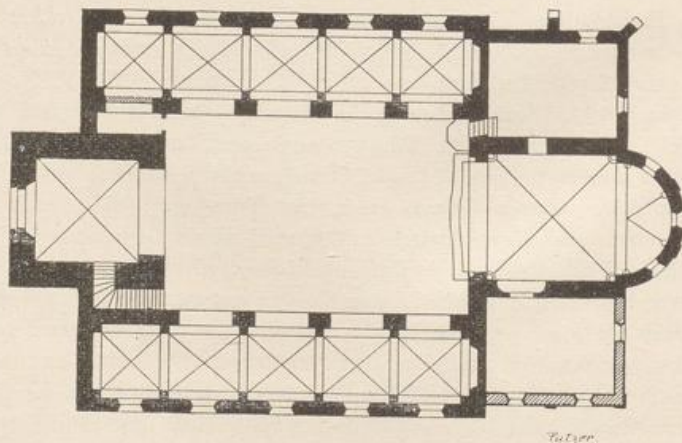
Wittlaer. Grundriss der katholischen Pfarrkirche.
